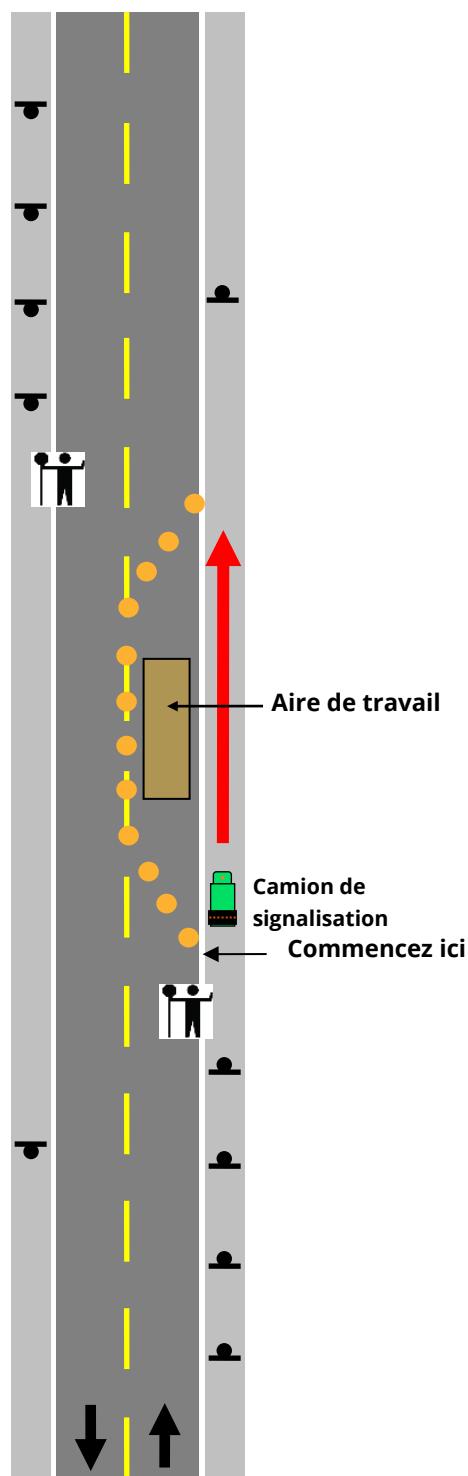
Installation pour la fermeture d'une voie (routes à deux voies)
